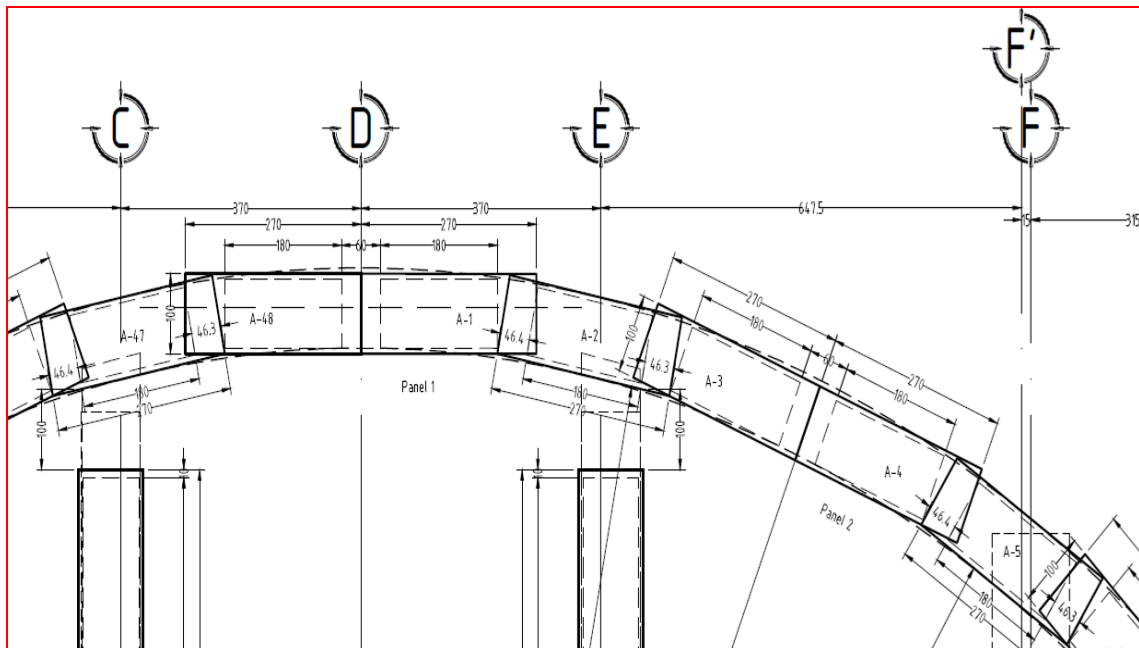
Corte en planta de la distribución de paneles de muro Milán. (CIMESA 2018).
